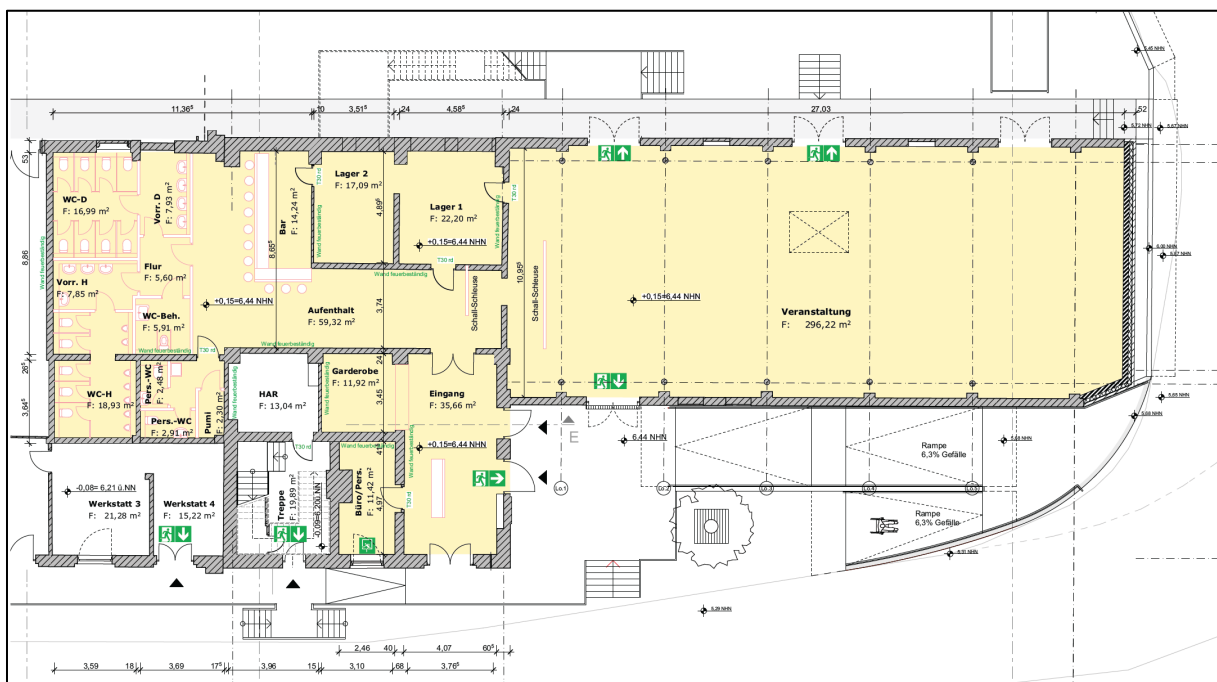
Grundriss der Mieteinheit (Der Grundriss wurde unter Hinzuziehung eines Clubplaners erarbeitet).
